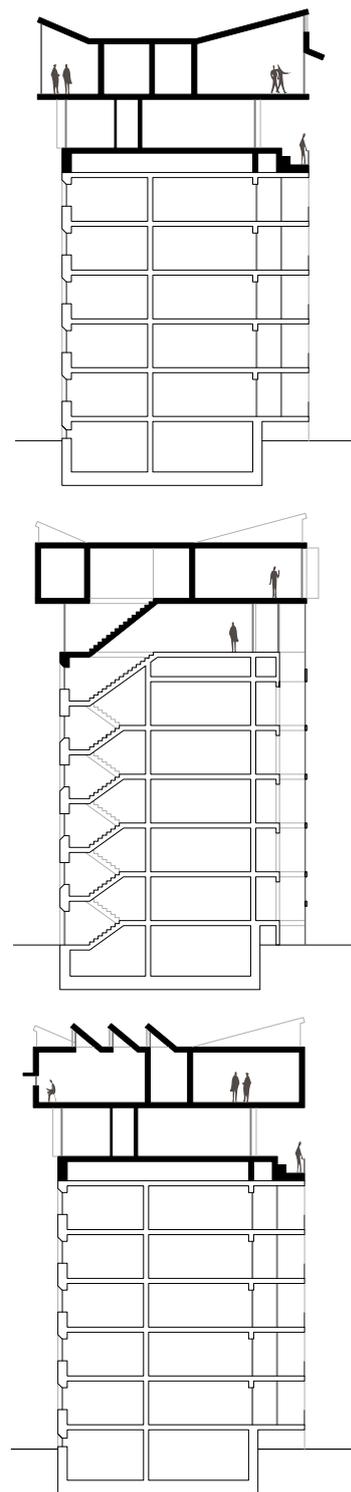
Querschnitte durch den Bestand und den Dachaufbau
